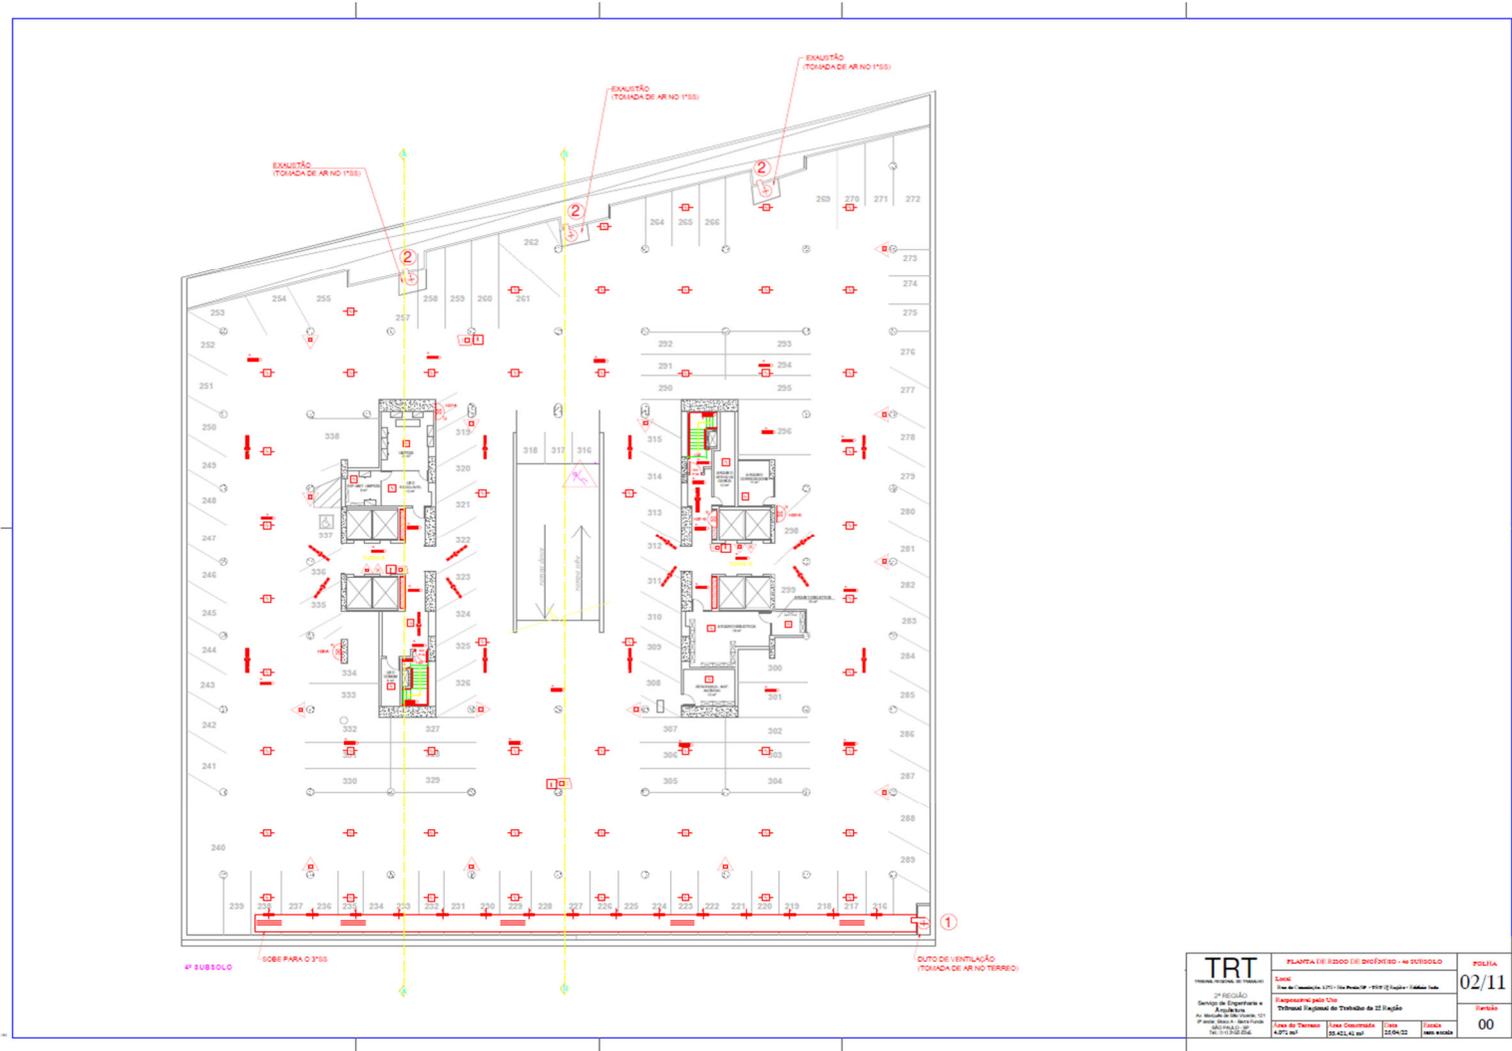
Planta de Risco de Incêndio - 4º Subsolo
